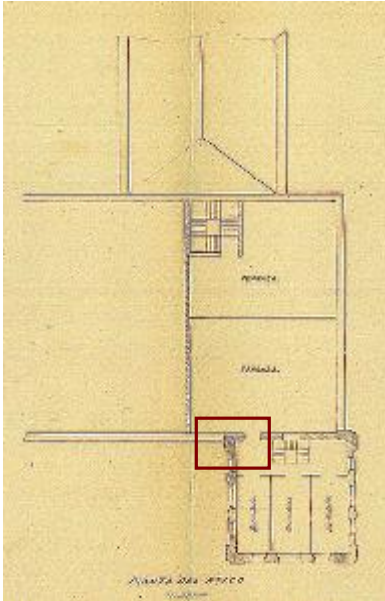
Planta de cubierta. Ed. de viajeros.
